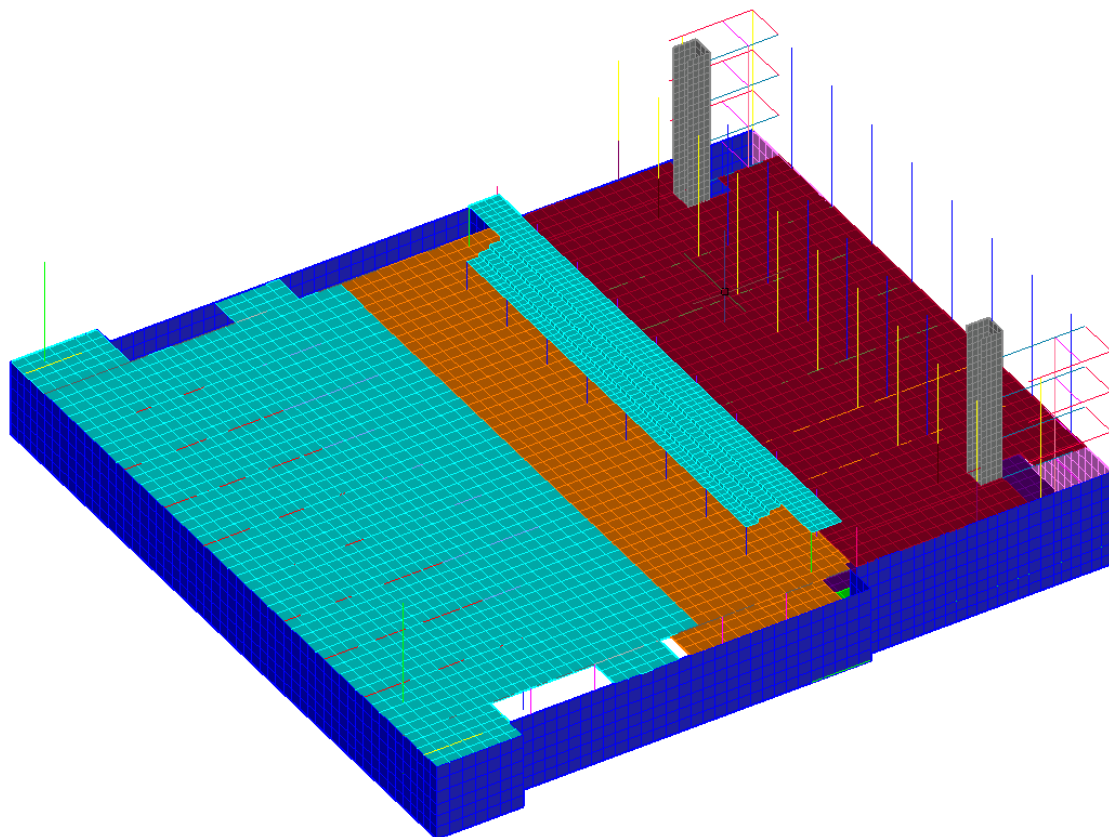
Modelo de cálculo del Pabellón y Aulario de la UFV. Planta baja. [Extraído de AutoCAD].
